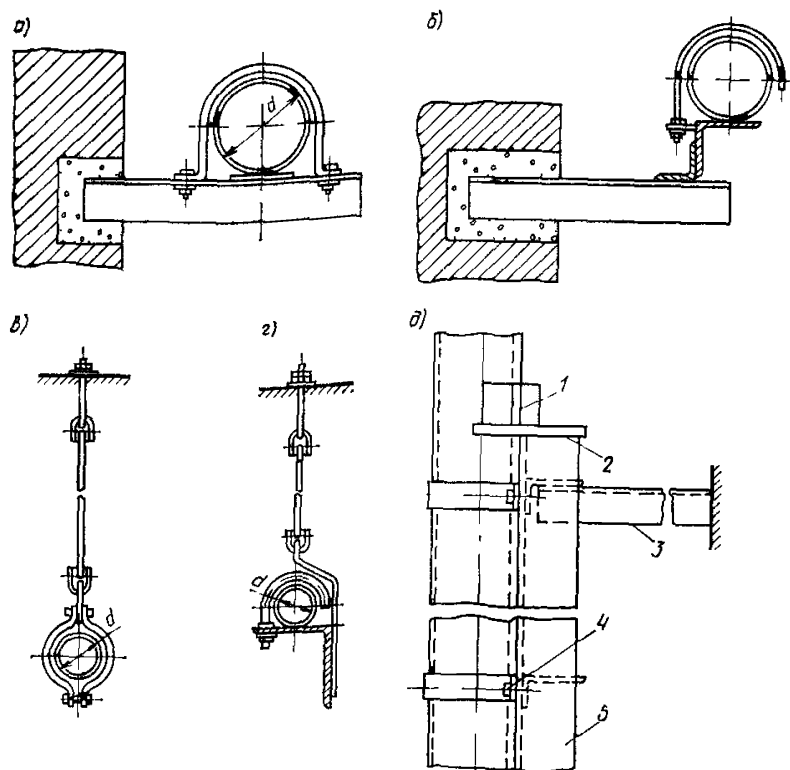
Опоры и подвески по ОСТ 36-17-77:
